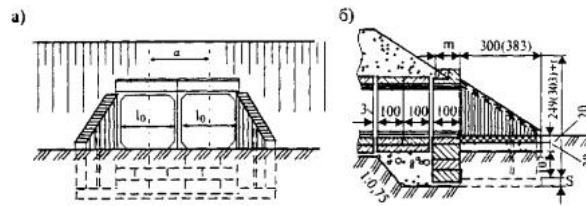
Прямоугольная двухочковая железобетонная труба:
